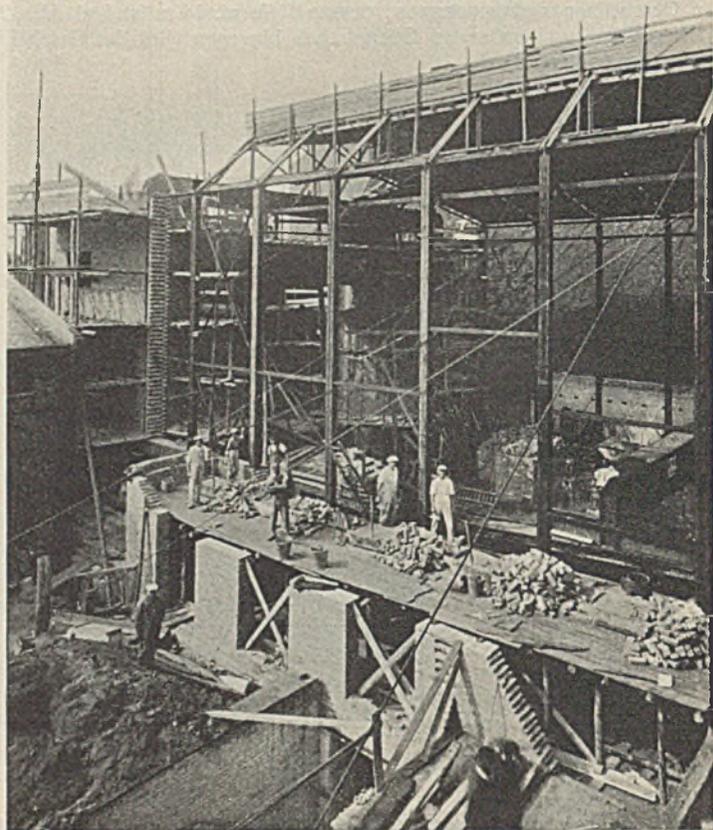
Dachbinder über dem Kino-Zuschauerraum. Das Bühnenhaus links ist z. T. hochgemauert, z. T. eingeschalt.
